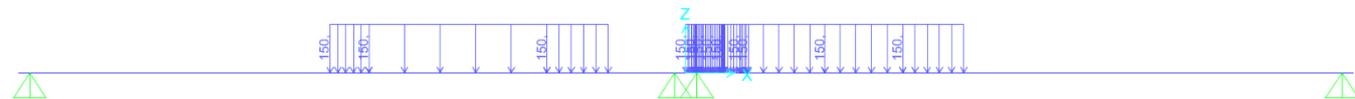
disposizione di carico 5 - SW/2 – pila 2
